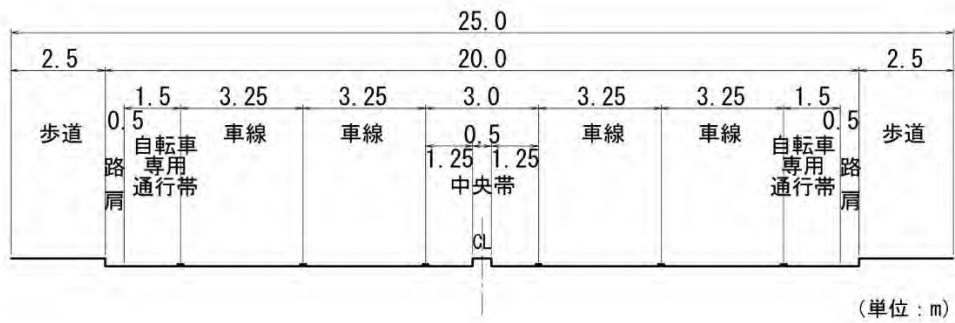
(3) 環状 4 号線 (北区間) の標準断面図
